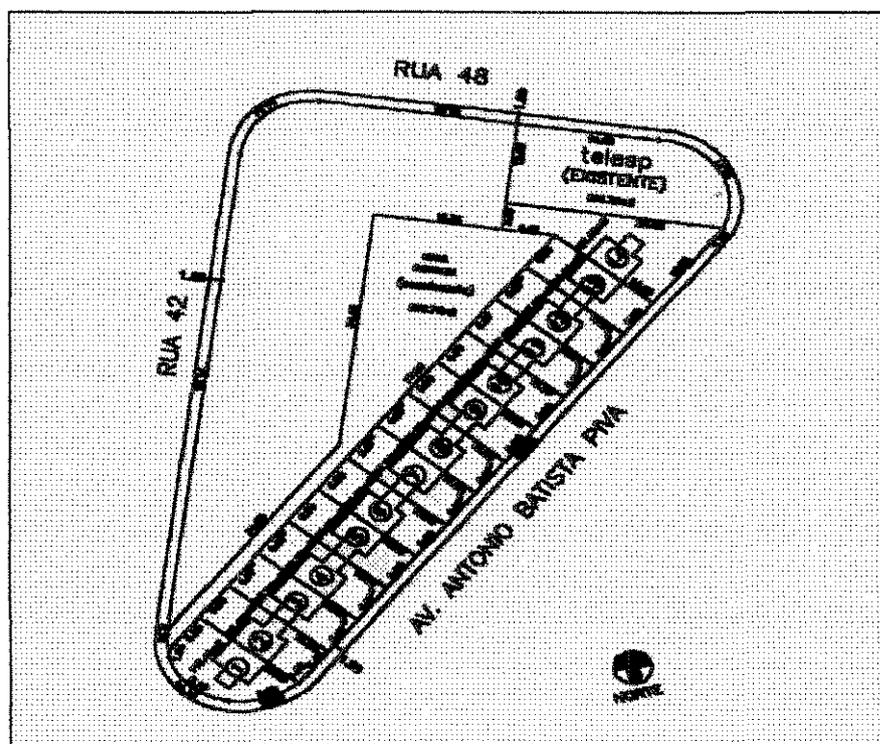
Implantação da Tipologia Sobrado “Projeto Bandeirante I” em Paulínia (SP) - 1997.
